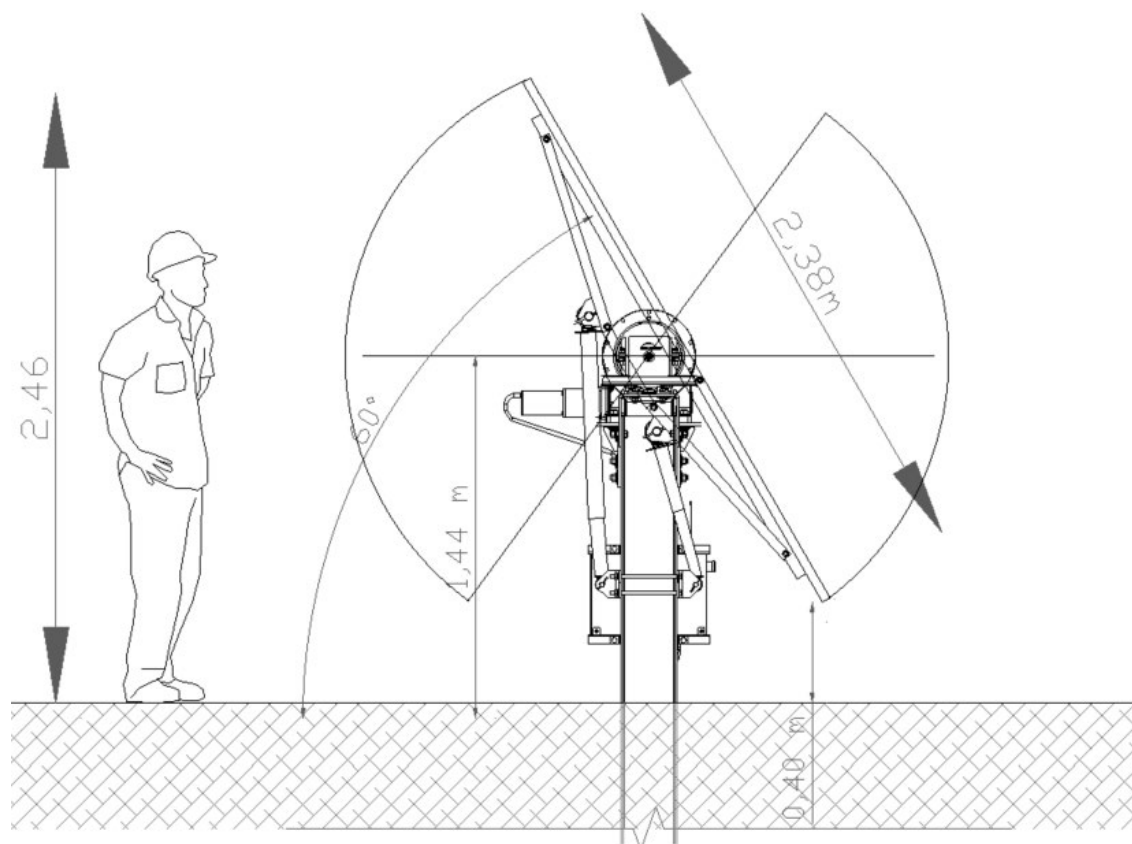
Esempio di tracker da installare nell'impianto agrivoltaico
